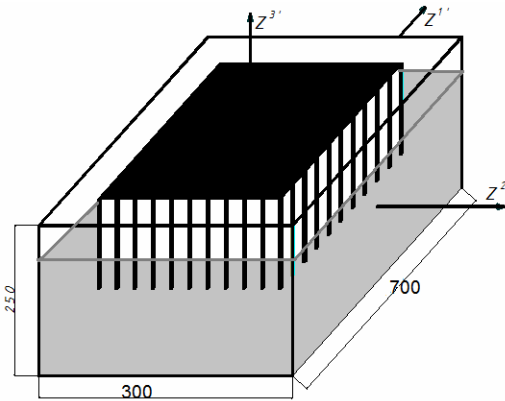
Розрахункова схема фундаментної плити з палями та фрагментом двошарового ґрунту
